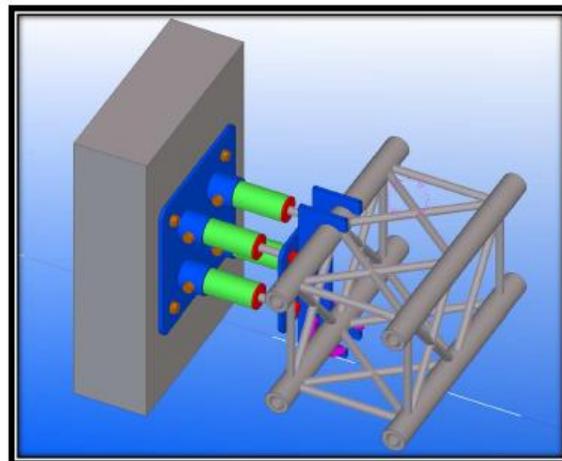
Ejemplo de detalles de anclaje Truss 3D (fuente: propia)
